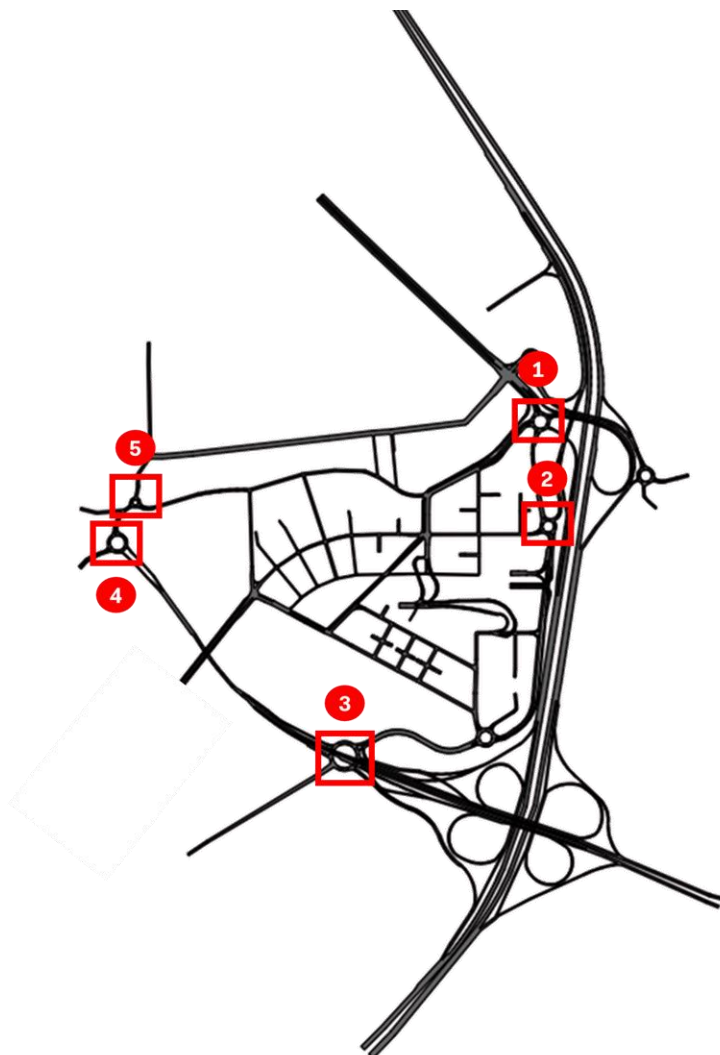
Key-Plan - Rotatorie di Progetto dell'area di Progetto
